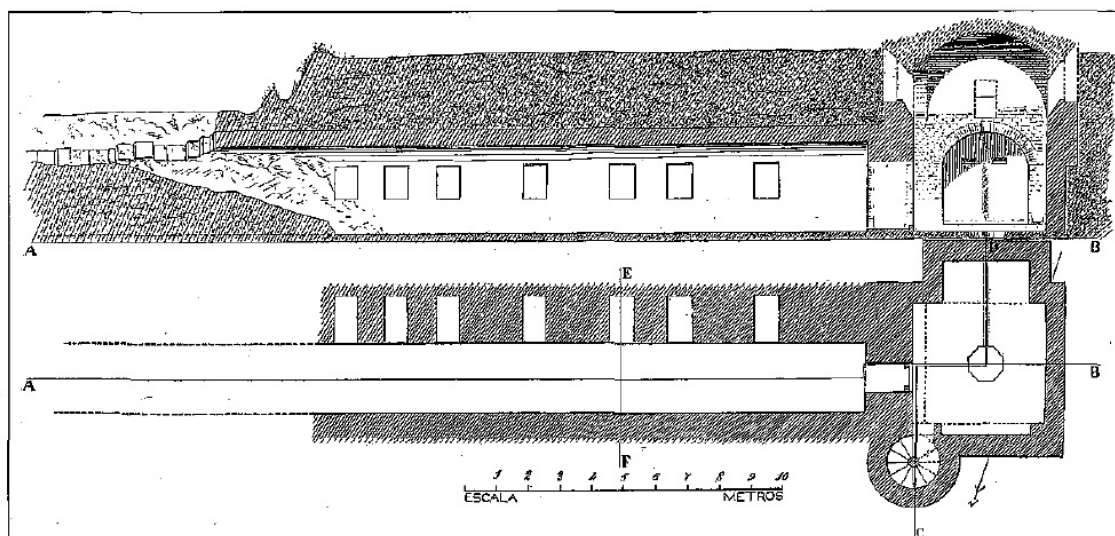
Planta y alzado de las estructuras de las Gabias (CABRÉ, 1923: Lam. III).
